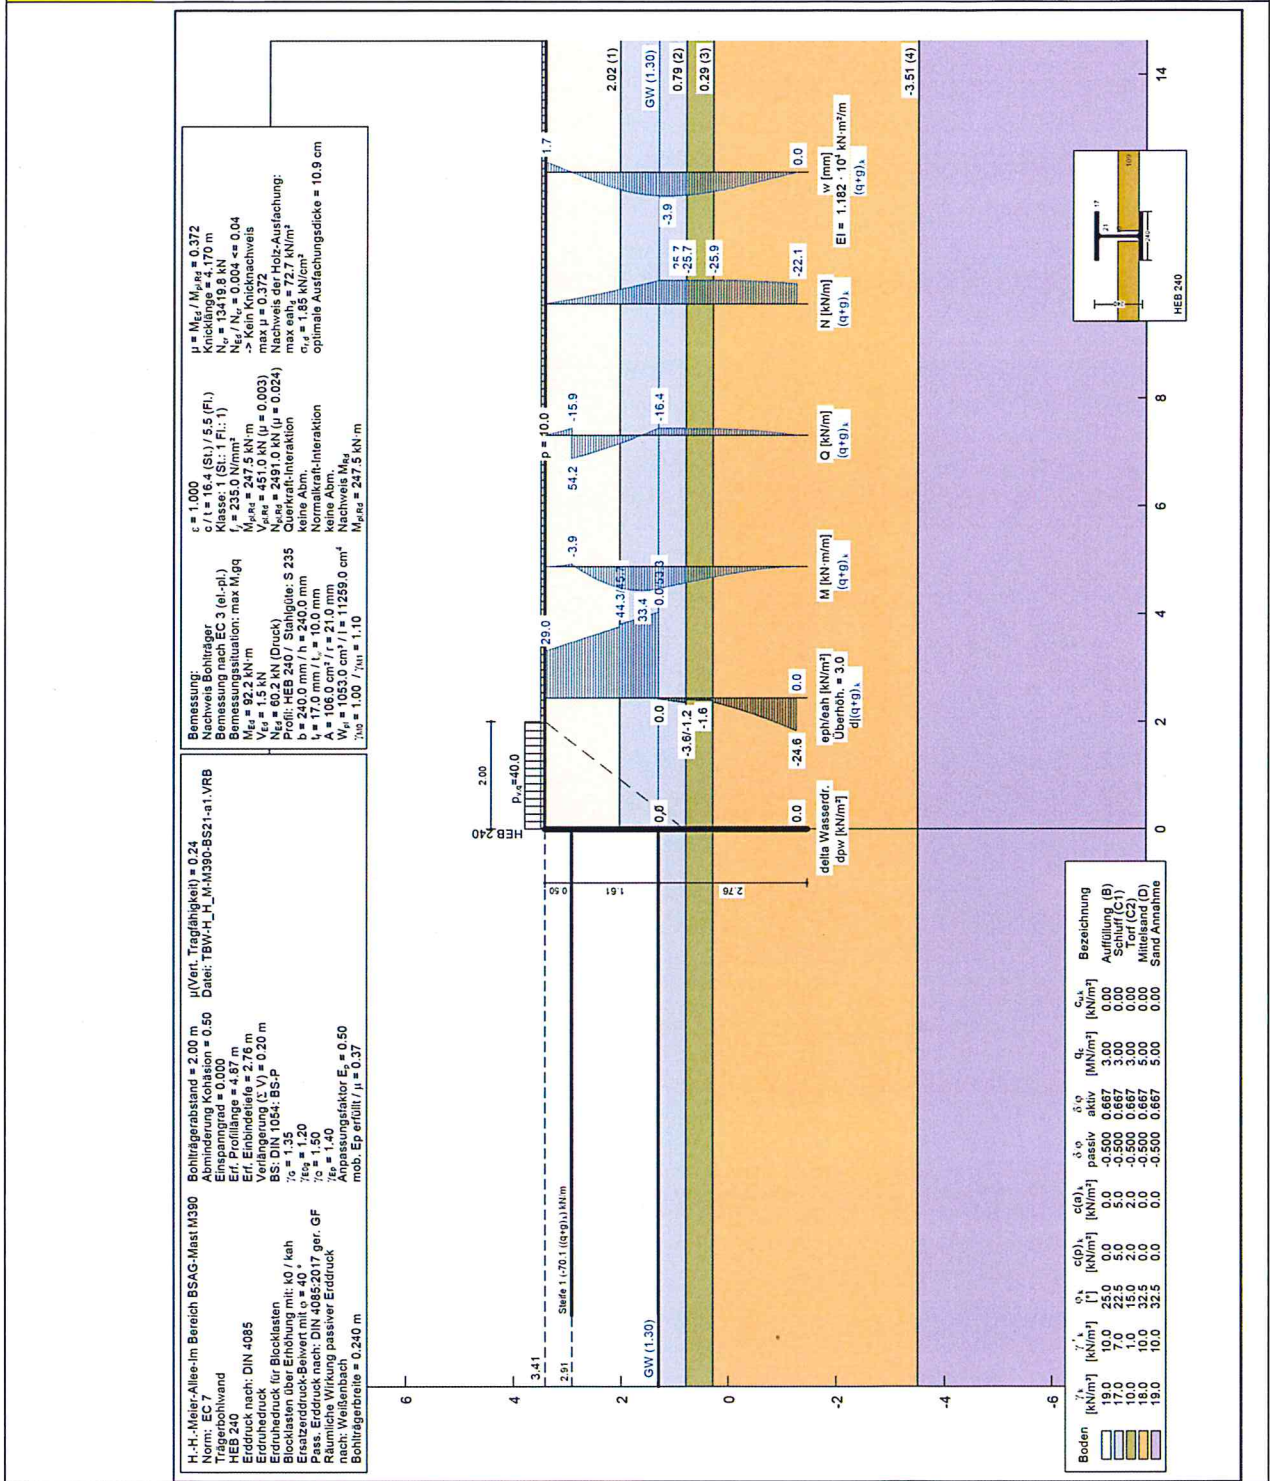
a2 Trägerbohlwand mit Baustellenlasten-BS23-a2
